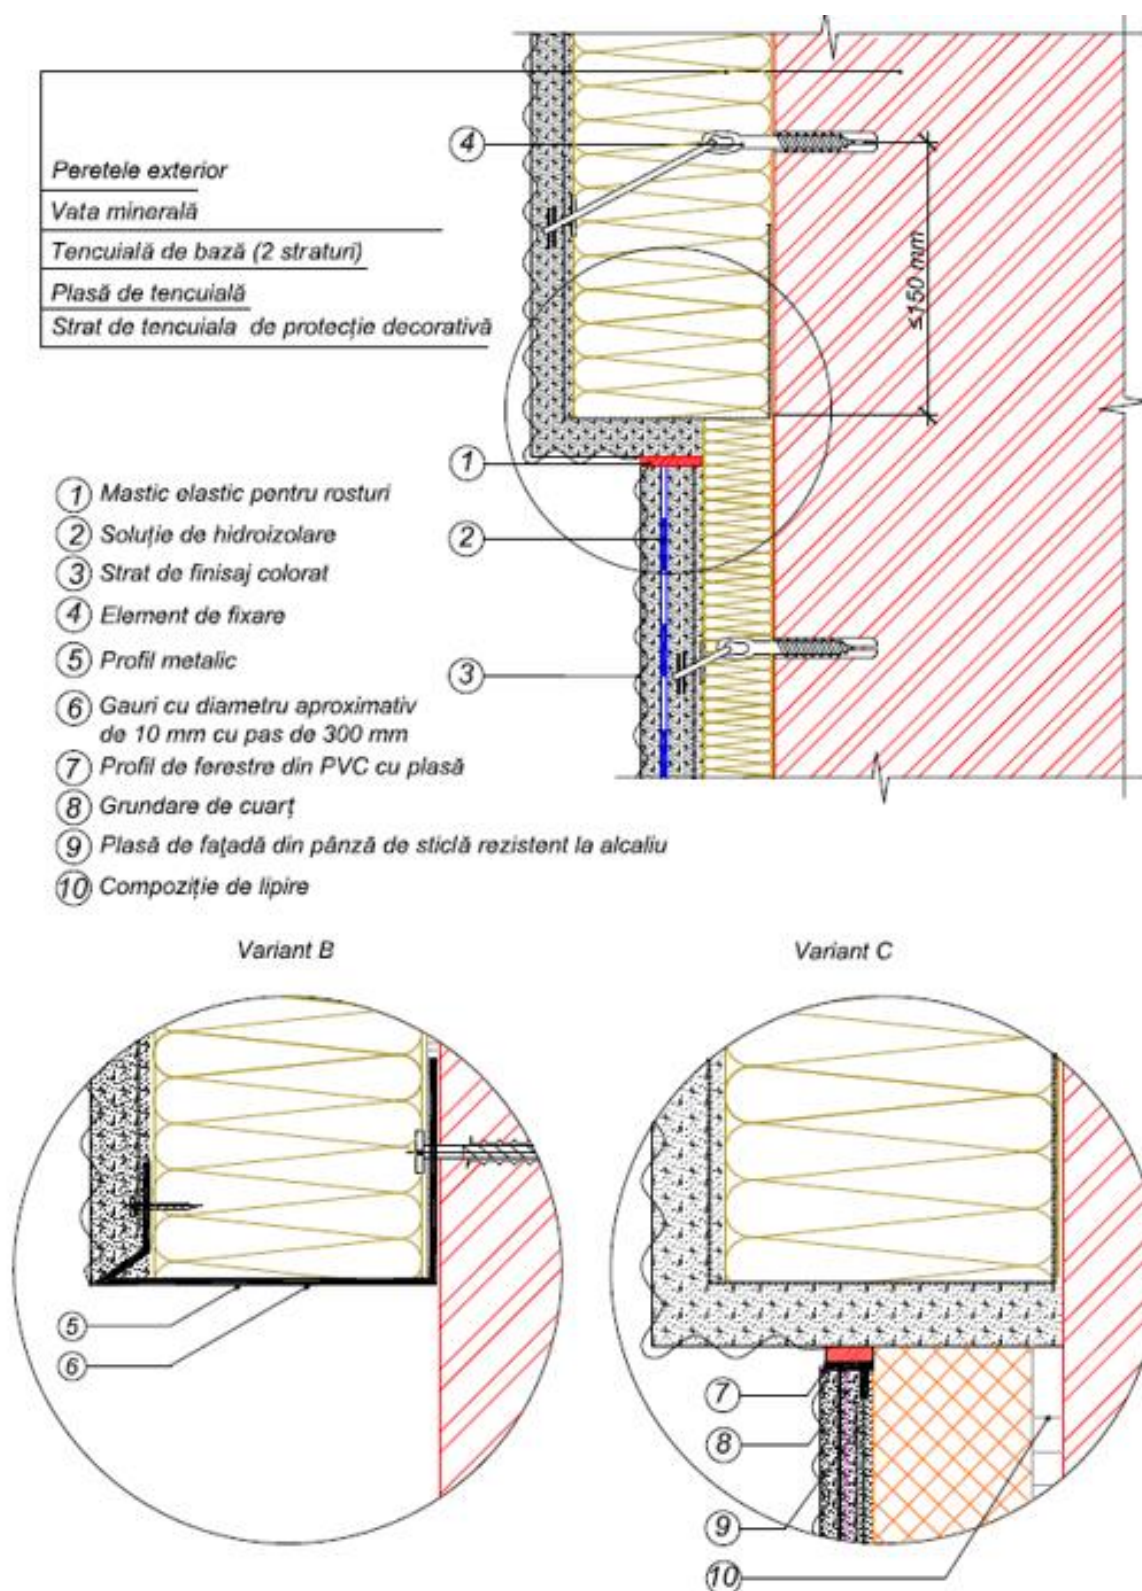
Alăturarea sistemului la soclu (Varianta A, B, C)
